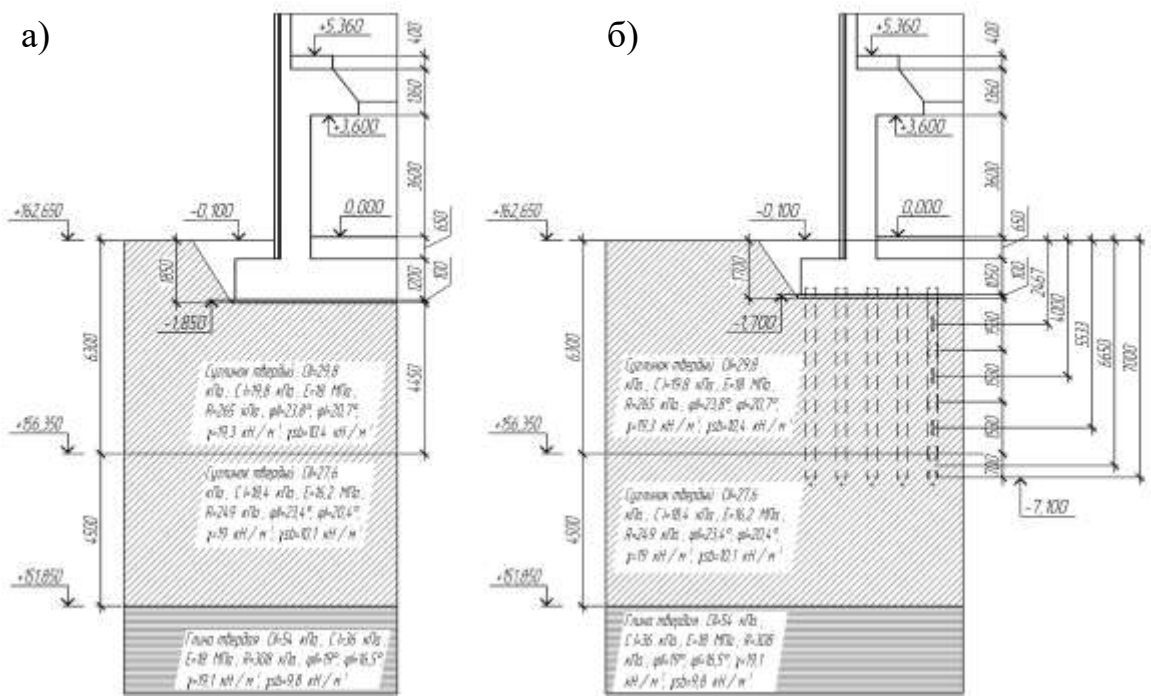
Схема глубины заложения фундамента и расположение границ слоев грунта относительно подошвы фундамента
